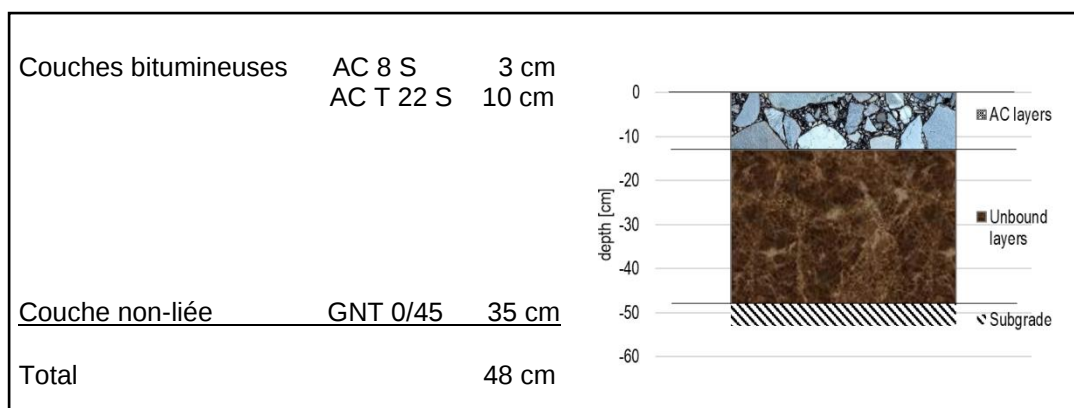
Structure de la chaussée de l'échantillon 1 avant renforcement
